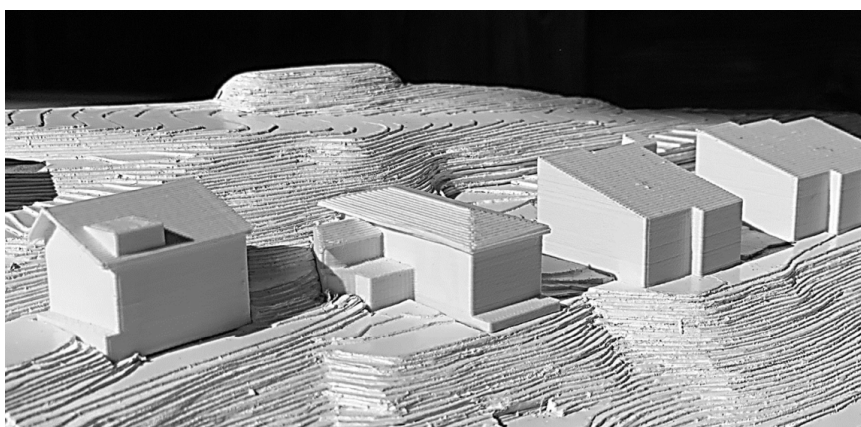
Situation Heute (Gebäude Stuckishausstrasse 15 mit Walmdach) und Nachbarbauten
